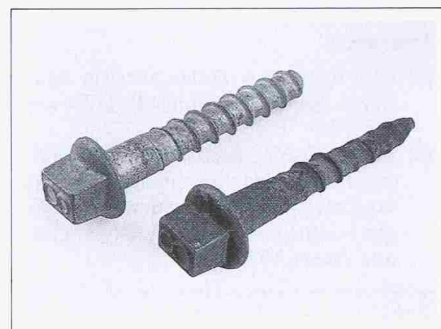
Erhebliche Querschnittsverminderung einer Eisenbahn-Schwellenschraube durch Korrosion
